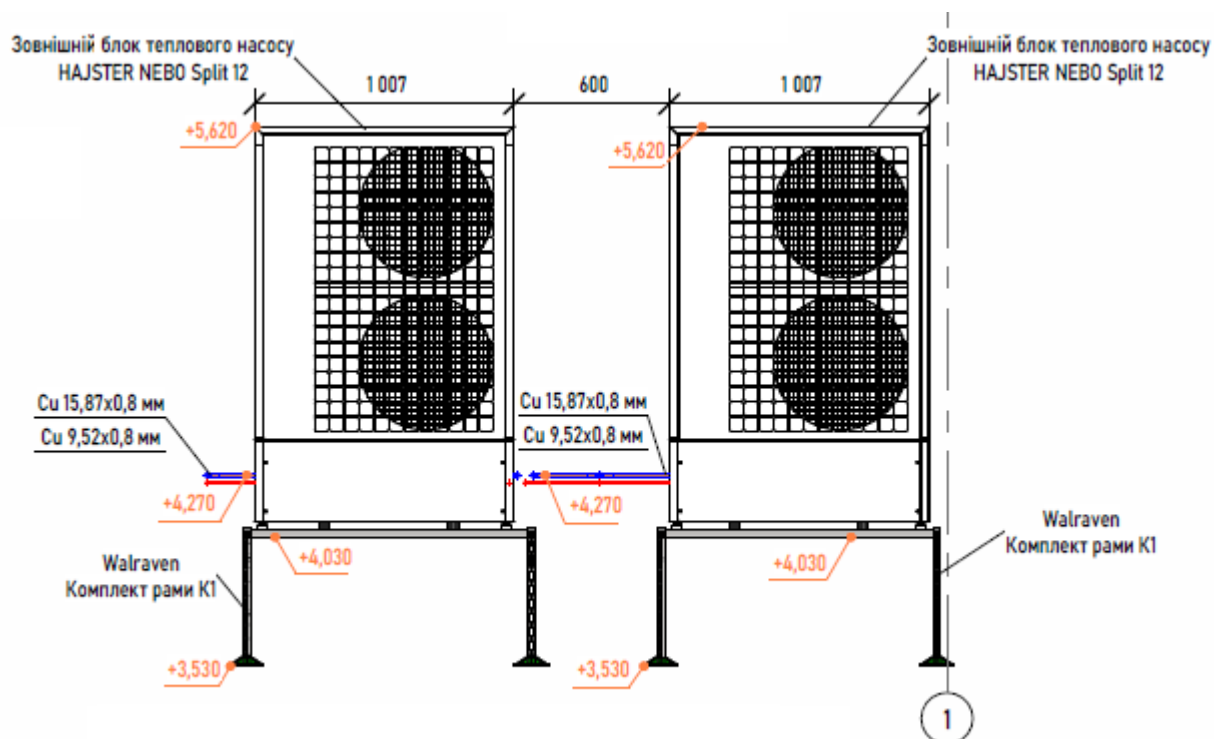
Розташування зовнішніх блоків. План 1-го поверху. Ч2
